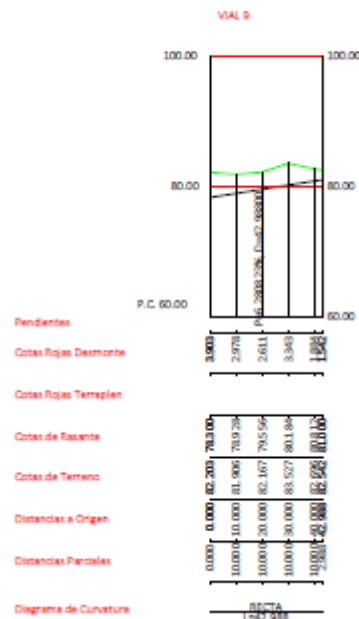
Imagen de la sección longitudinal del vial 9 en la alternativa 2.
